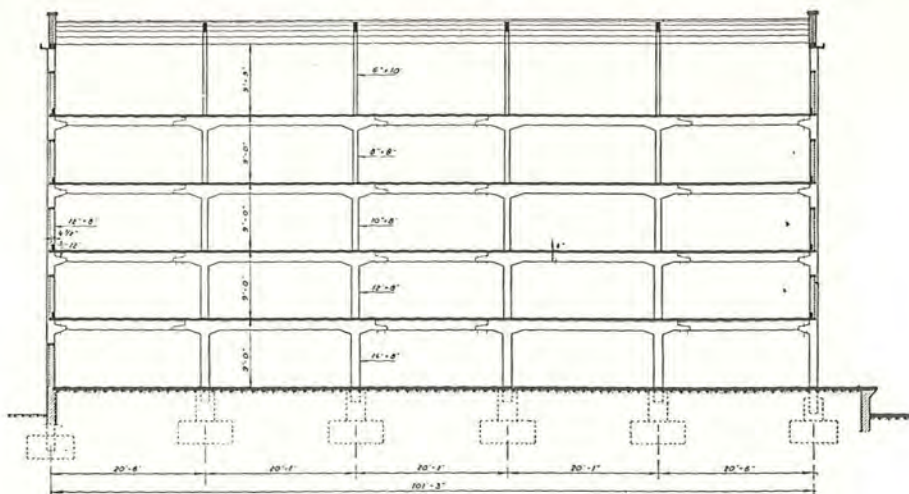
Tværsnit i en jernbetonskeletbygning opført af prefabrikerede elementer, der er boltede sammen.
